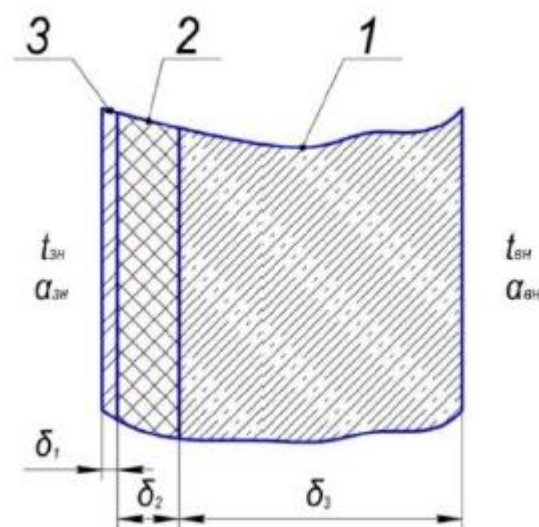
Фрагмент зовнішньої стіни будівлі
